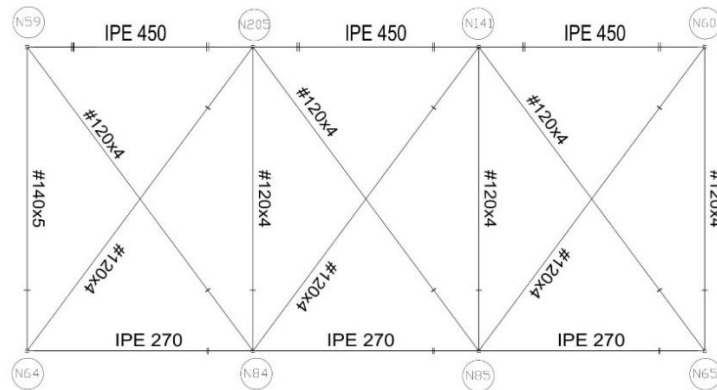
Perfiles de una mitad de la Viga Pratt. Fuente: Elaboración propia a partir de CYPE 3D
